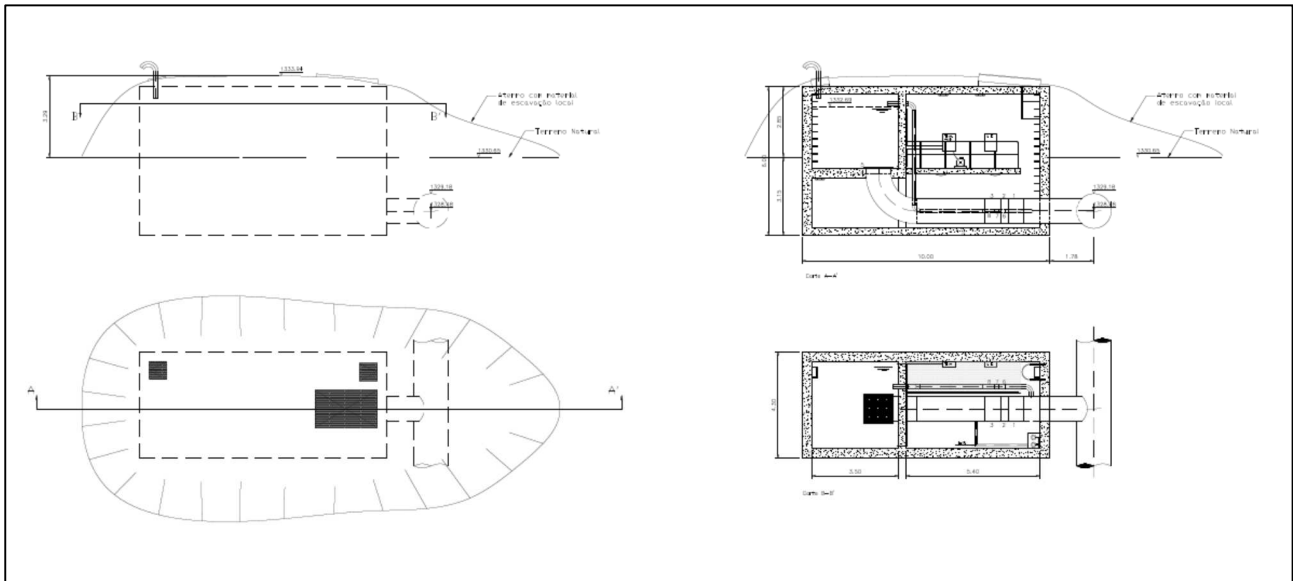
Pormenores da implantação do RUD (cortes longitudinais e implantação)
